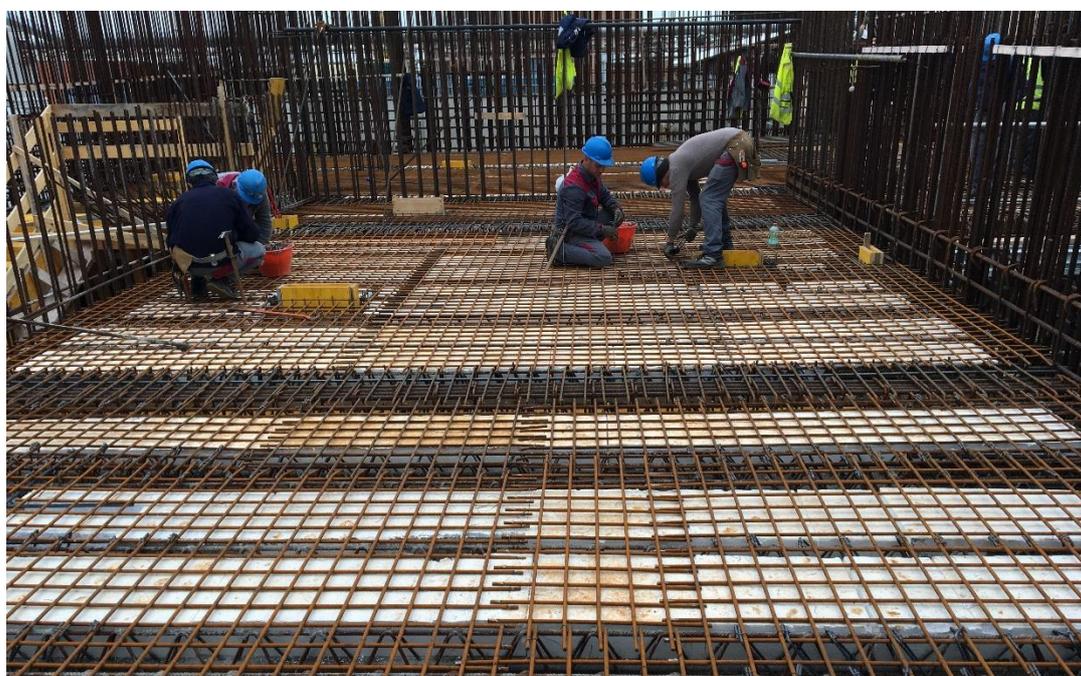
/4 – Foto di cantiere durante il montaggio del solaio prefabbricato
